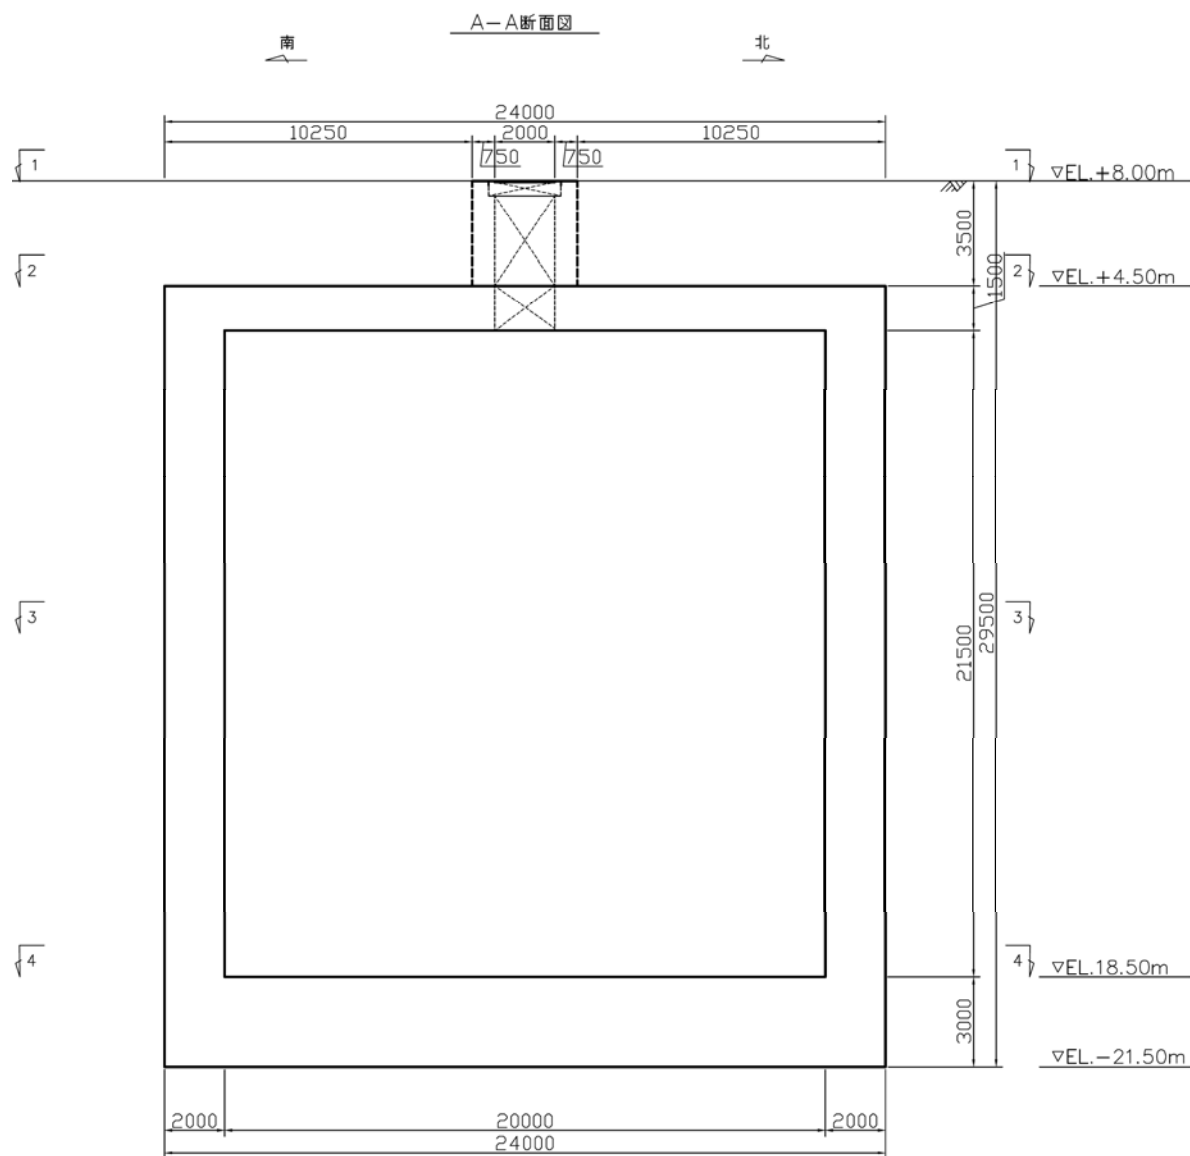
(2) 代替淡水贮槽断面图 (南北方向断面)
